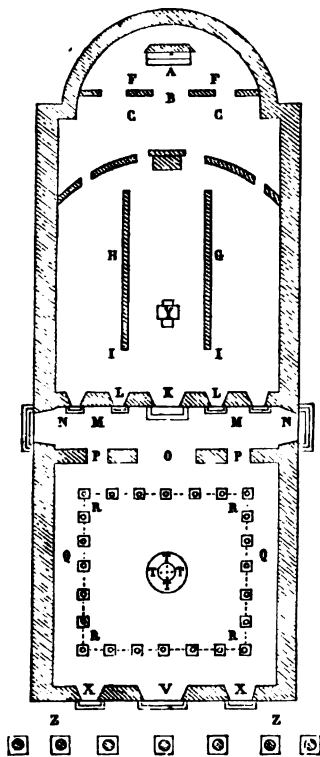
Grundriss einer altchristlichen Basilika.
